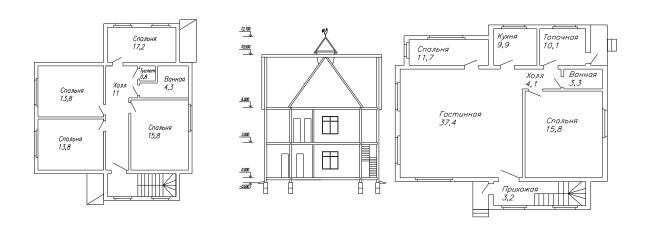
План 1-го и 2-го этажей. Разрез дома
